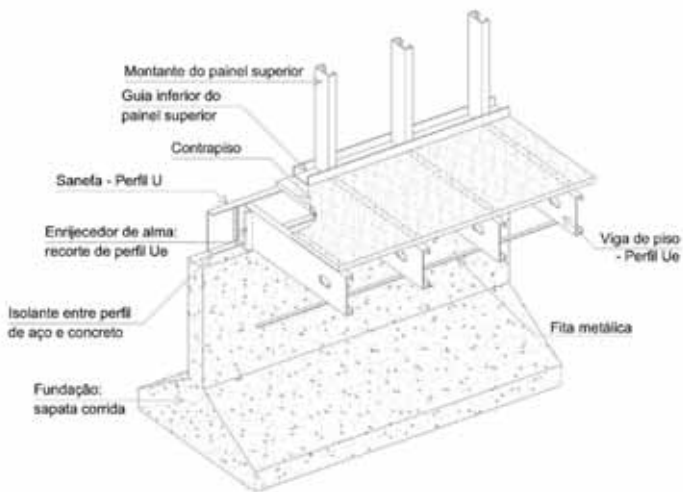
Laje em Light Steel Framing apoiada sobre fundação tipo sapata corrida
